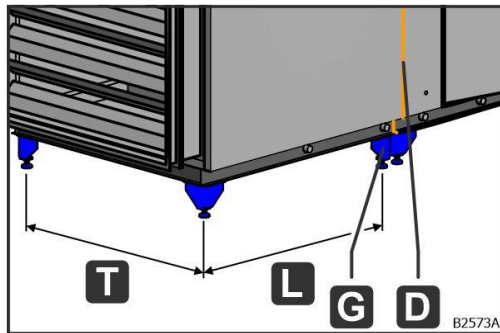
Fondations ponctuelles pour centrales sur châssis DIN (dimensionnement)
